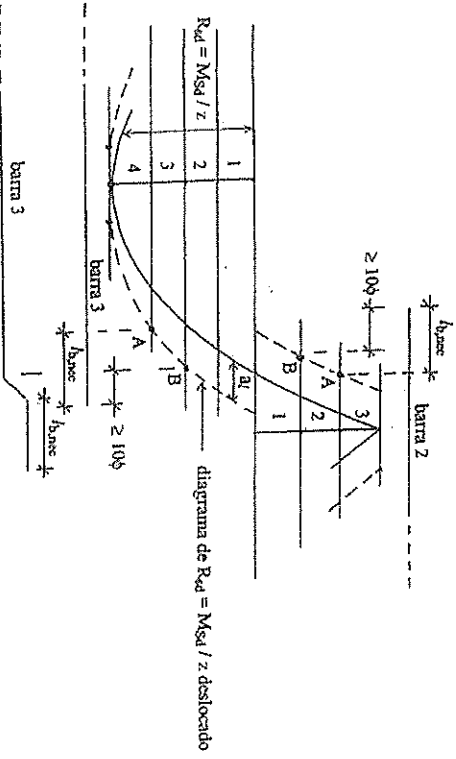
Ancoragem de barras longitudinais tracionadas fora do apoio
